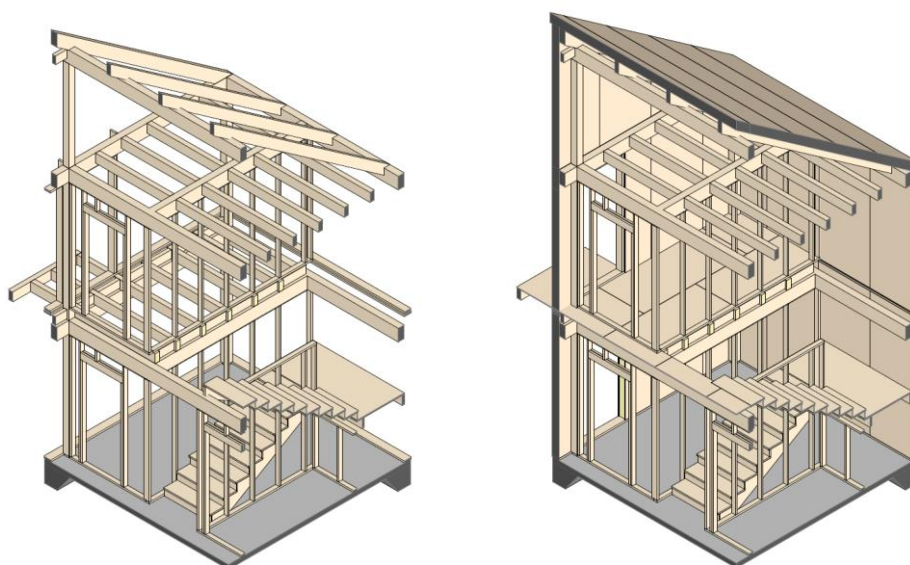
Tipo estrutural principal e Tipo estrutural com integração da envolvente em painéis sanduiche (SIP).
